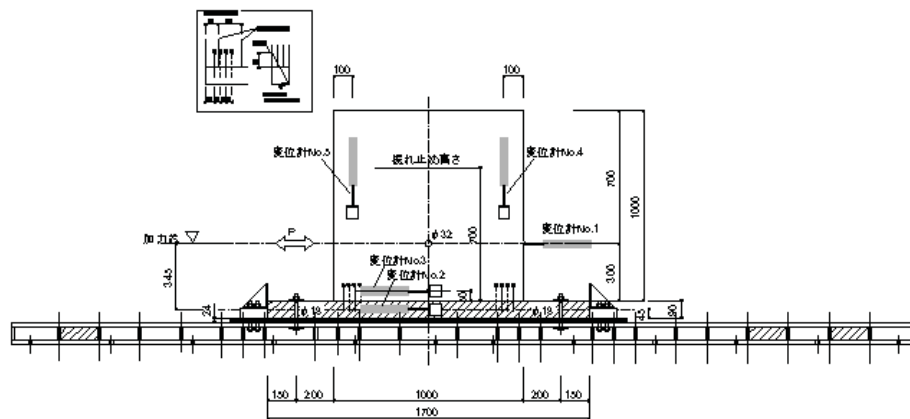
長ビス(純せん断) 試験体立面図 (NB1-3)
